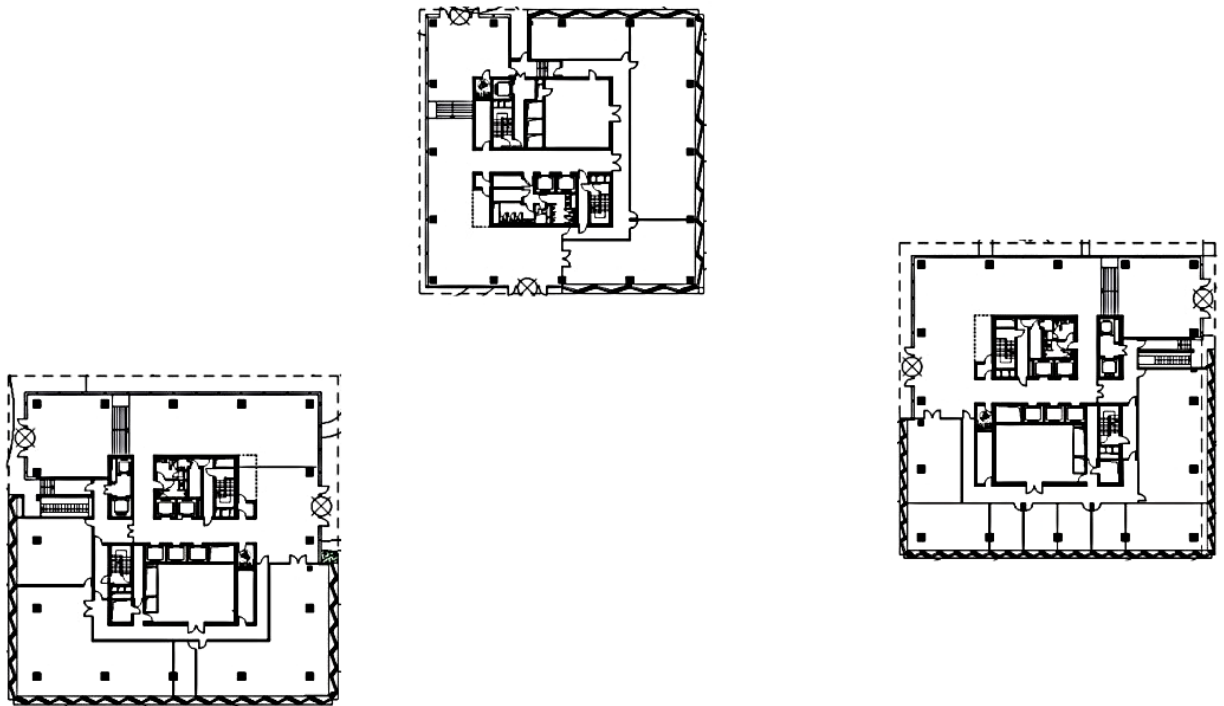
Планування типового поверху Бізнес-центру 3 Cubes
